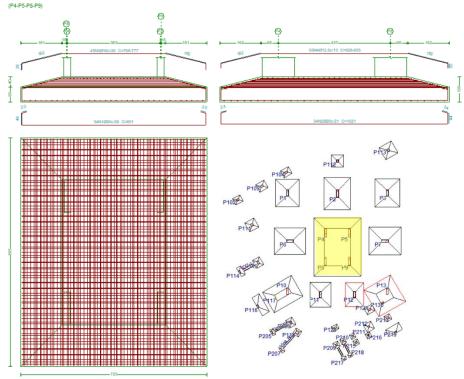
Sapata Associada (P4-P5-P8-P9) detalhamento de dimensões e armaduras contidas no elemento estrutural.
